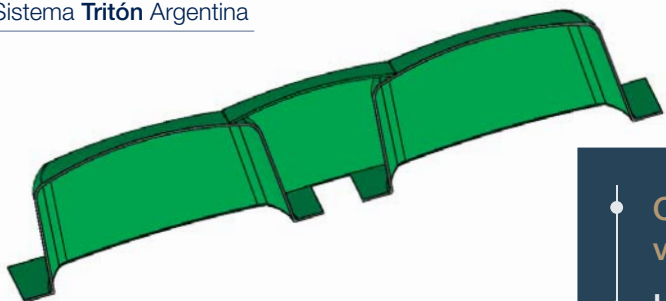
/ Corte longitudinal del conjunto armado casetón - conector - casetón
